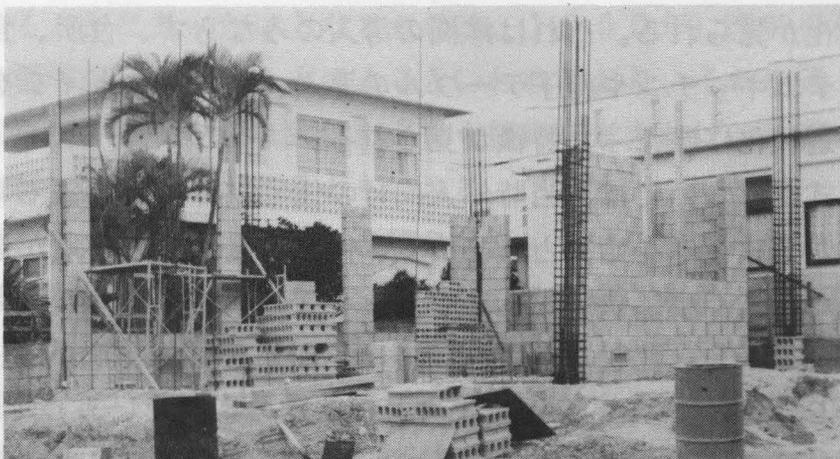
コンクリート造ラーメン構法の民間住宅（ブロック先積）
